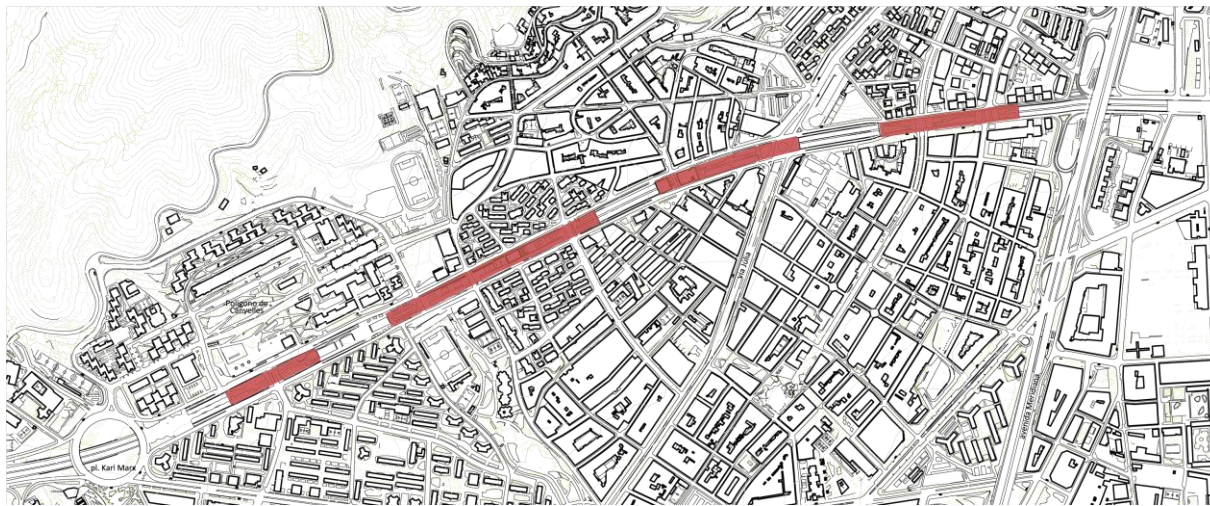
Ubicación de las losas de cobertura en el proyecto de Ribas Piera de 1984. Elaboración propia.
